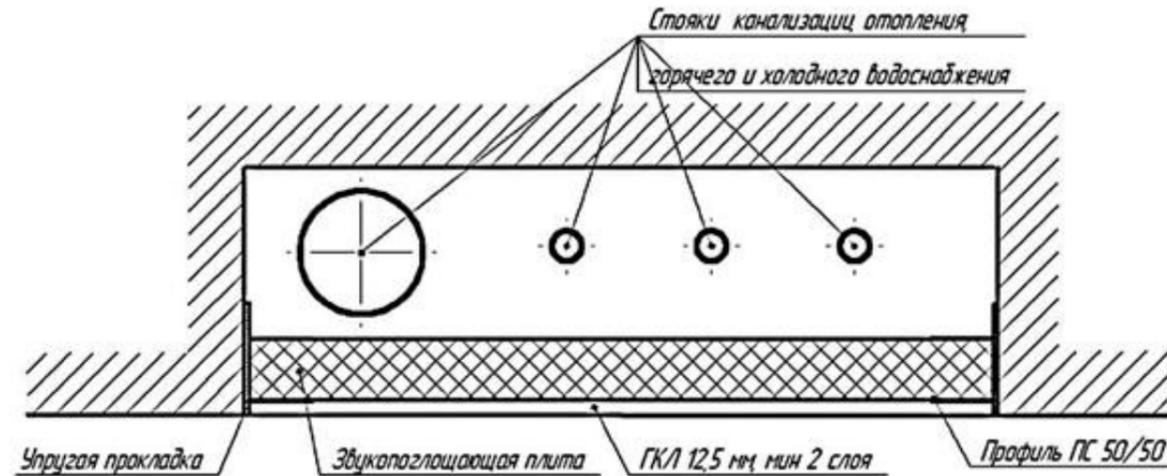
Узел звукоизоляционного короба для стояков канализации, водоснабжения и отопления
